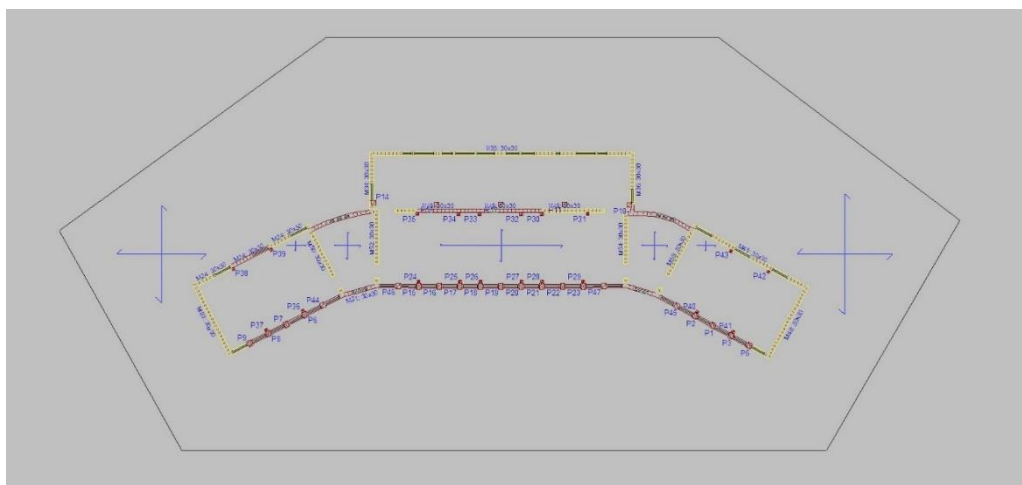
Planta baja del modelo de 5 plantas simplificado
